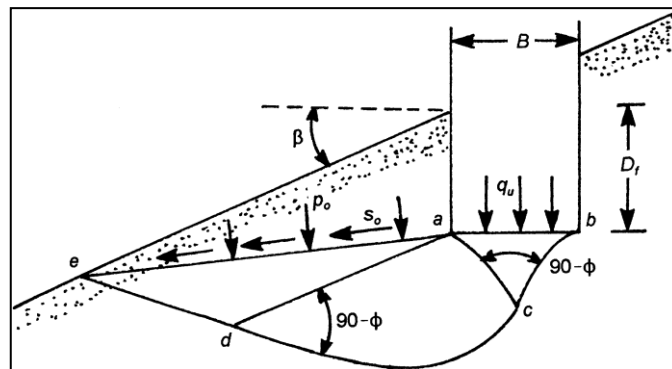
Nature de la zone plastique sous une fondation filante rugueuse située sur une pente.
